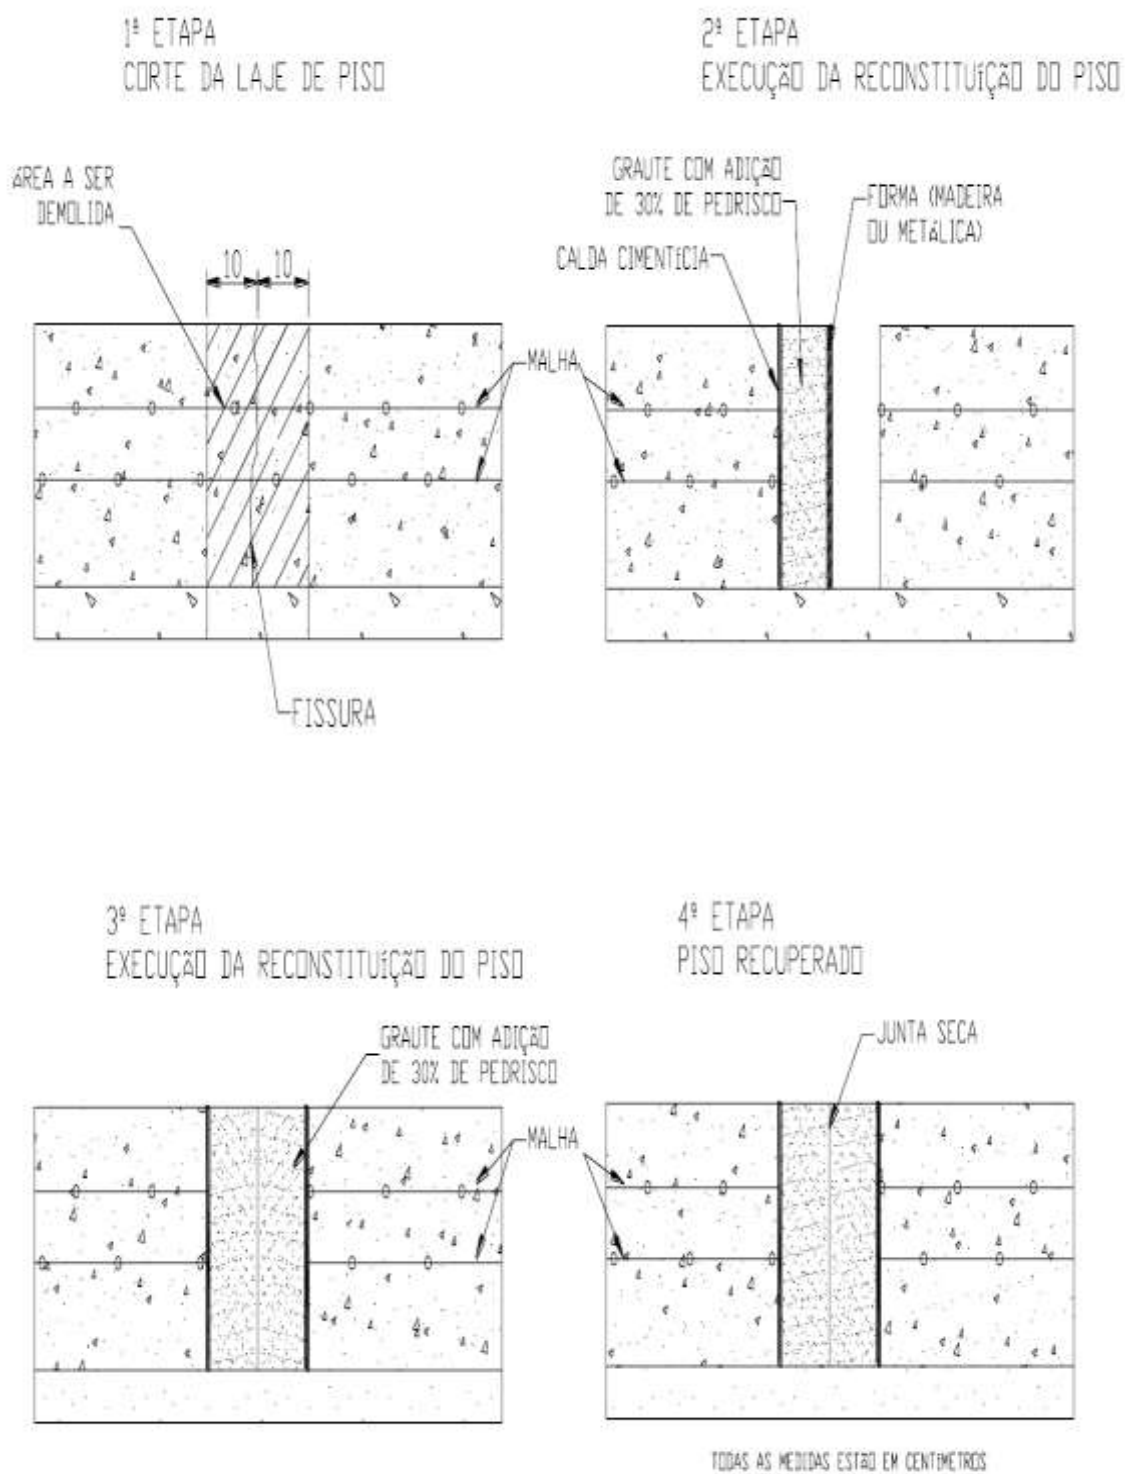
Detalhe executivo das etapas de recuperação das fissuras
